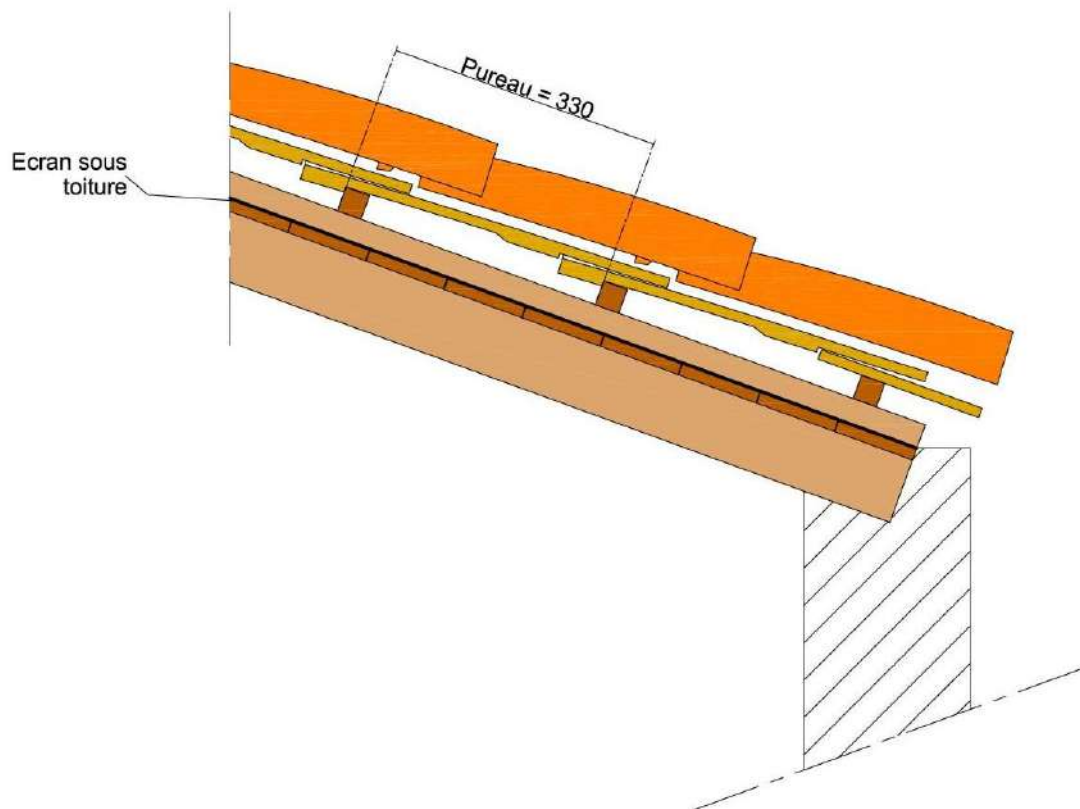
Pose sur volige, écran sous toiture, contre liteau et liteau
